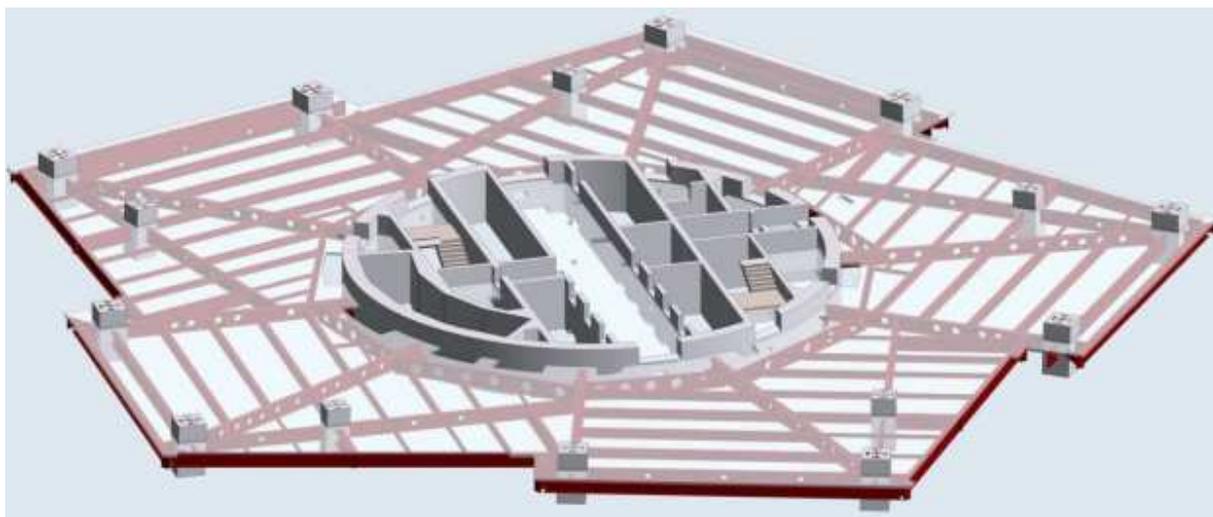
Фрагмент сталежелезобетонного перекрытия
